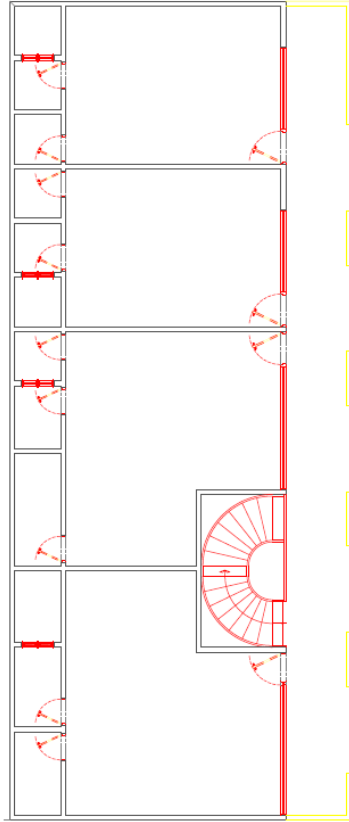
Planta arquitectónica 2 y 3 Nivel.
